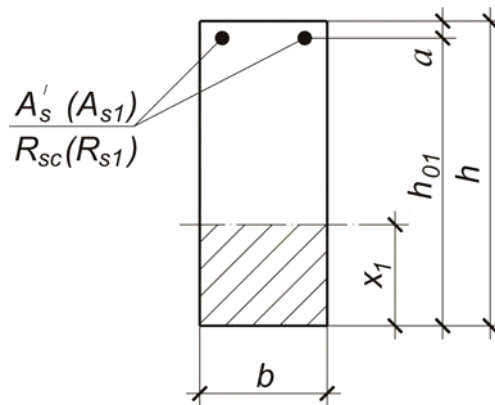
Расчетное сечение балки над промежуточной опорой
